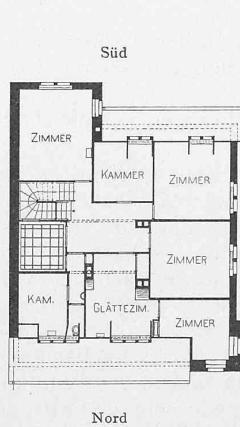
, 43 und 44. Grundrisse vom Erdgeschoss und den zwei Obergeschoßen. — Maßstab 1 : 400.
